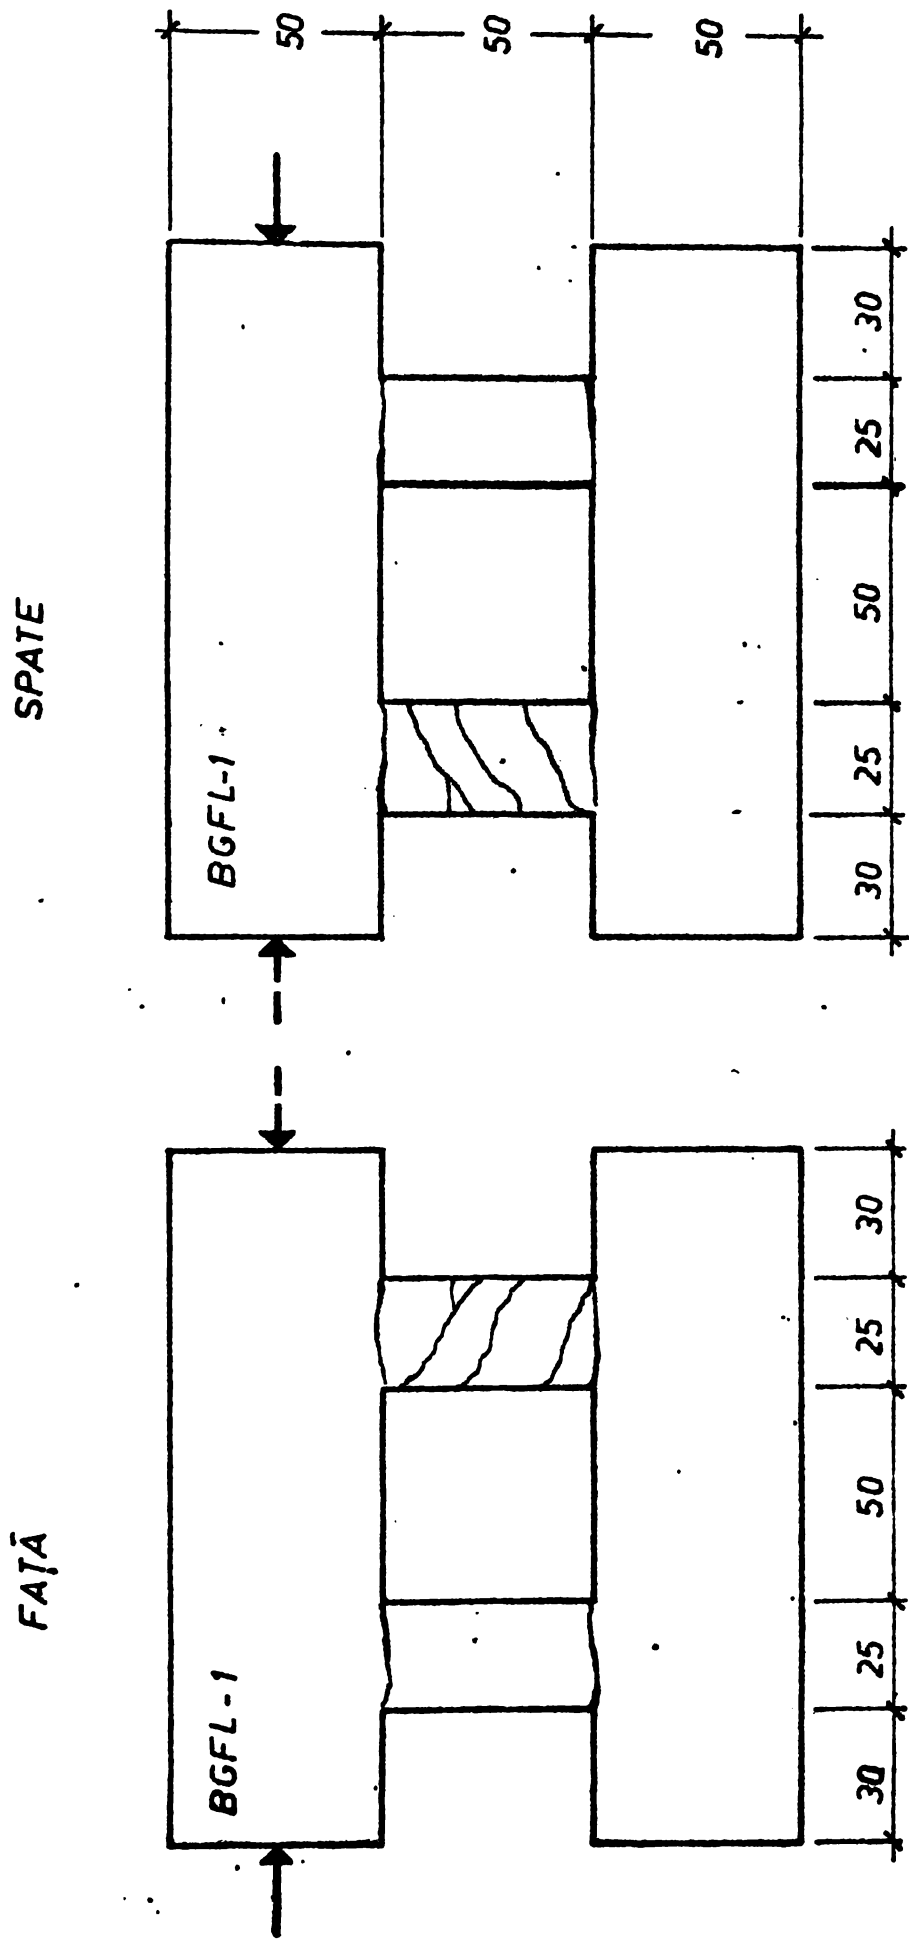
MODUL DE FISURARE A BUIANDRUGILOR ELEMENTULUI BGFL-1 LA RUPERE
